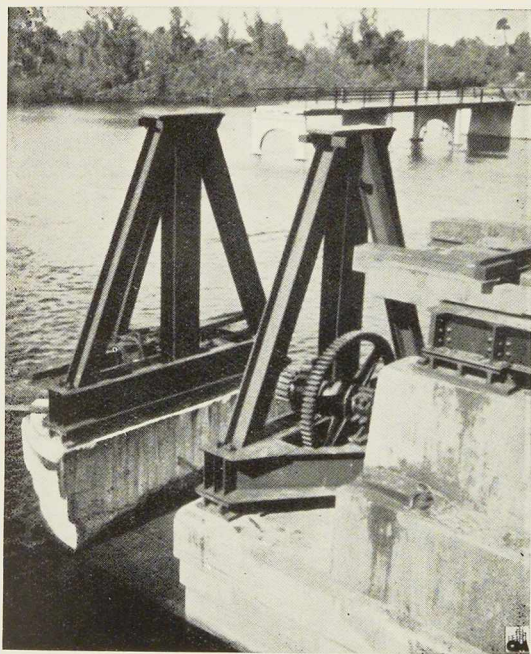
Supports de tourillons du pont, dont on remarque la légèreté. Précédemment, on avait utilisé pour ces supports des profils composés par rivure.
